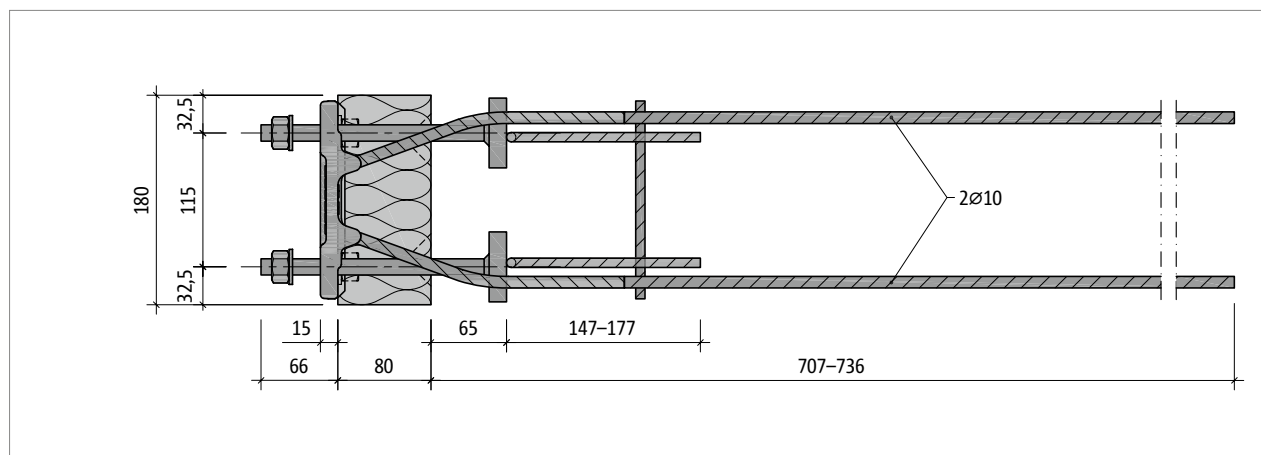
Schöck Isokorb® T type SQ-V2 : vue en plan
